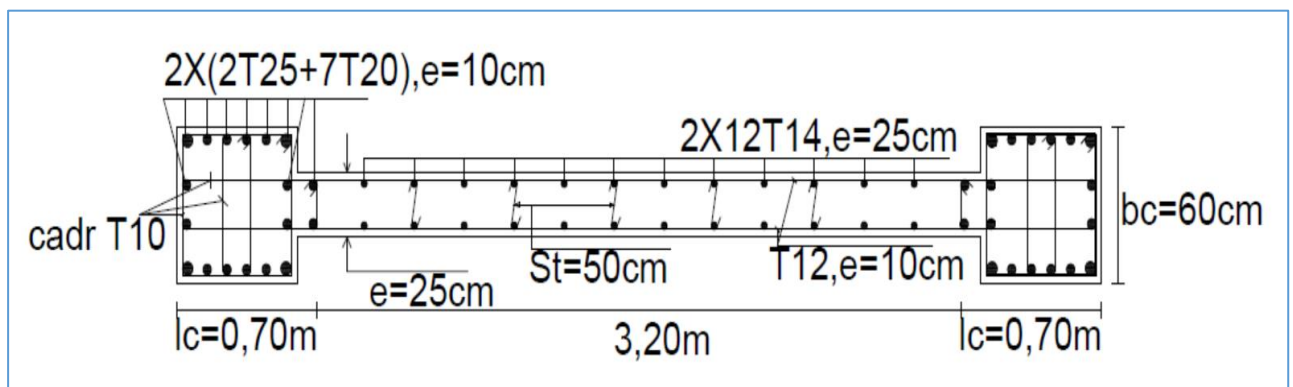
La coupe de ferrailage des voile sens y épaisseur 25cm.
